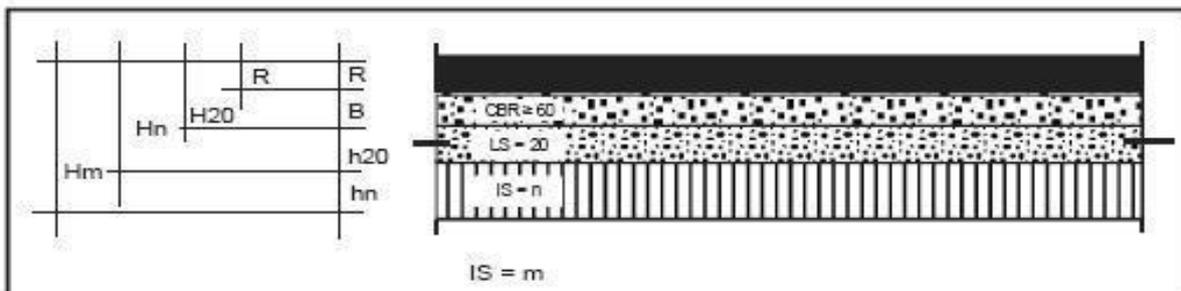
Ábaco de Dimensionamento de Pavimentos (Fonte: Manual de Dimensionamento de Pavimentos do DNIT – 2006)
